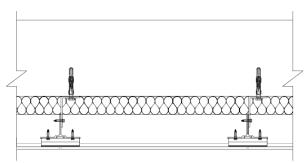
Kit Tempio® FK con perfiles discontinuos. Sección horizontal.
